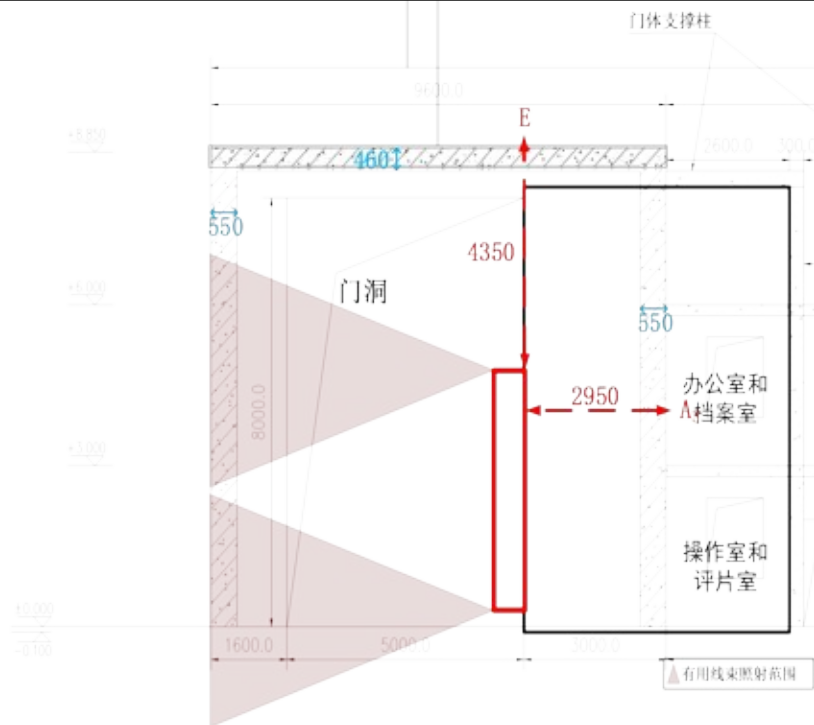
定向探伤机关注点位示意图（剖面图，单位：mm）
